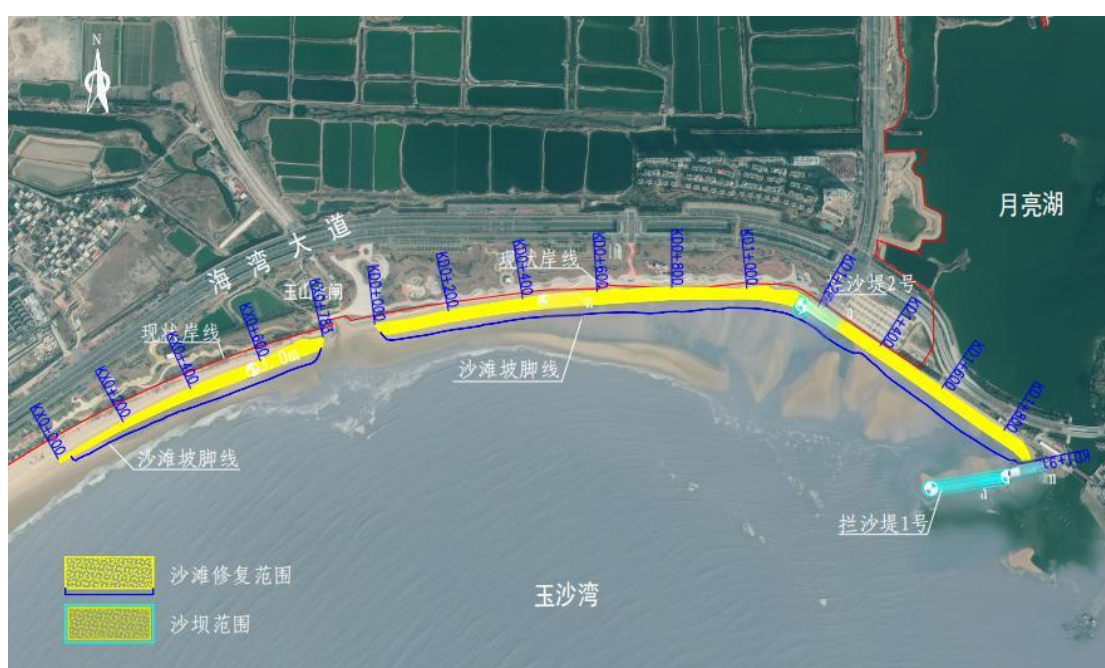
玉沙湾砂质岸线修复平面布置图（方案一）
